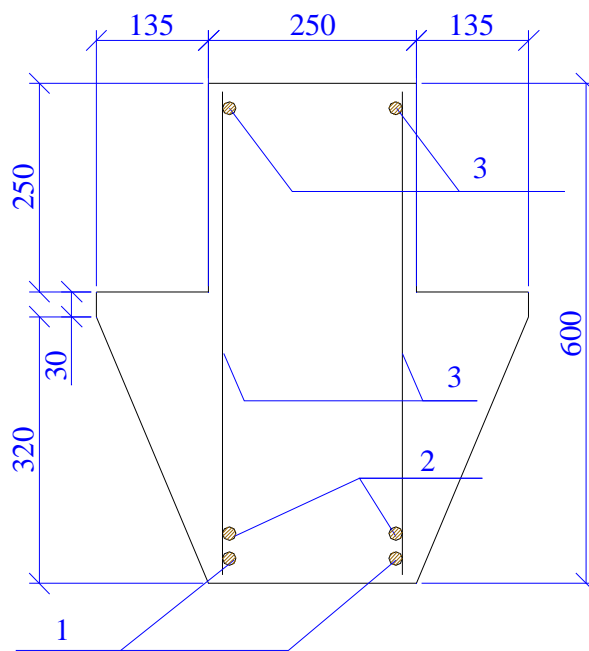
Ригель перекрытия над первым и вторым этажами.
